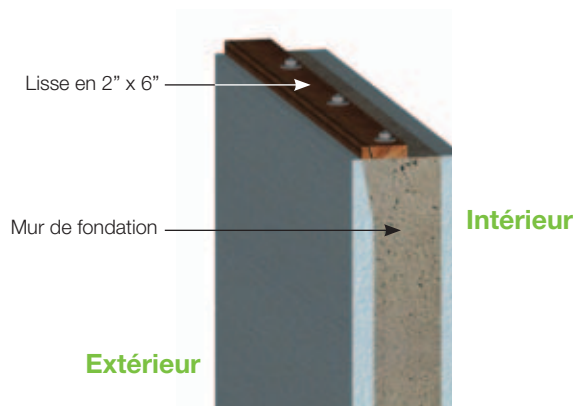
• Détail type d'un ancrage sur fondation de coffrage isolant
